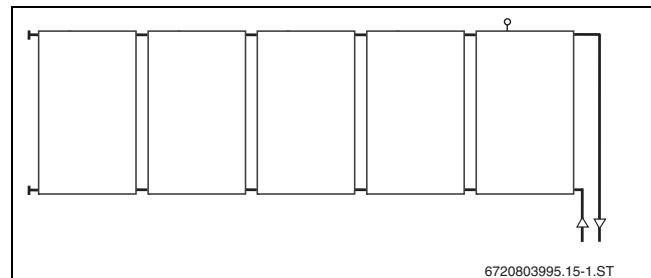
Collegamento sullo stesso lato a destra o a sinistra (1 fila)
